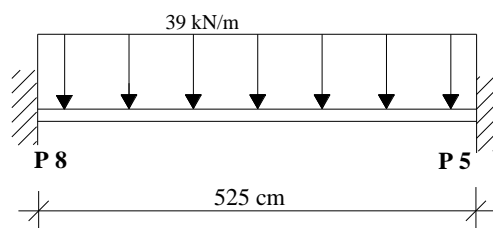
Esquema estático e carregamento no vão da viga adjacente ao pilar P5.
